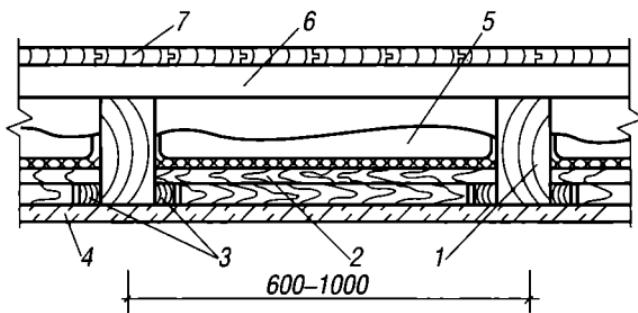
Конструкция междуэтажного перекрытия по деревянным балкам:
